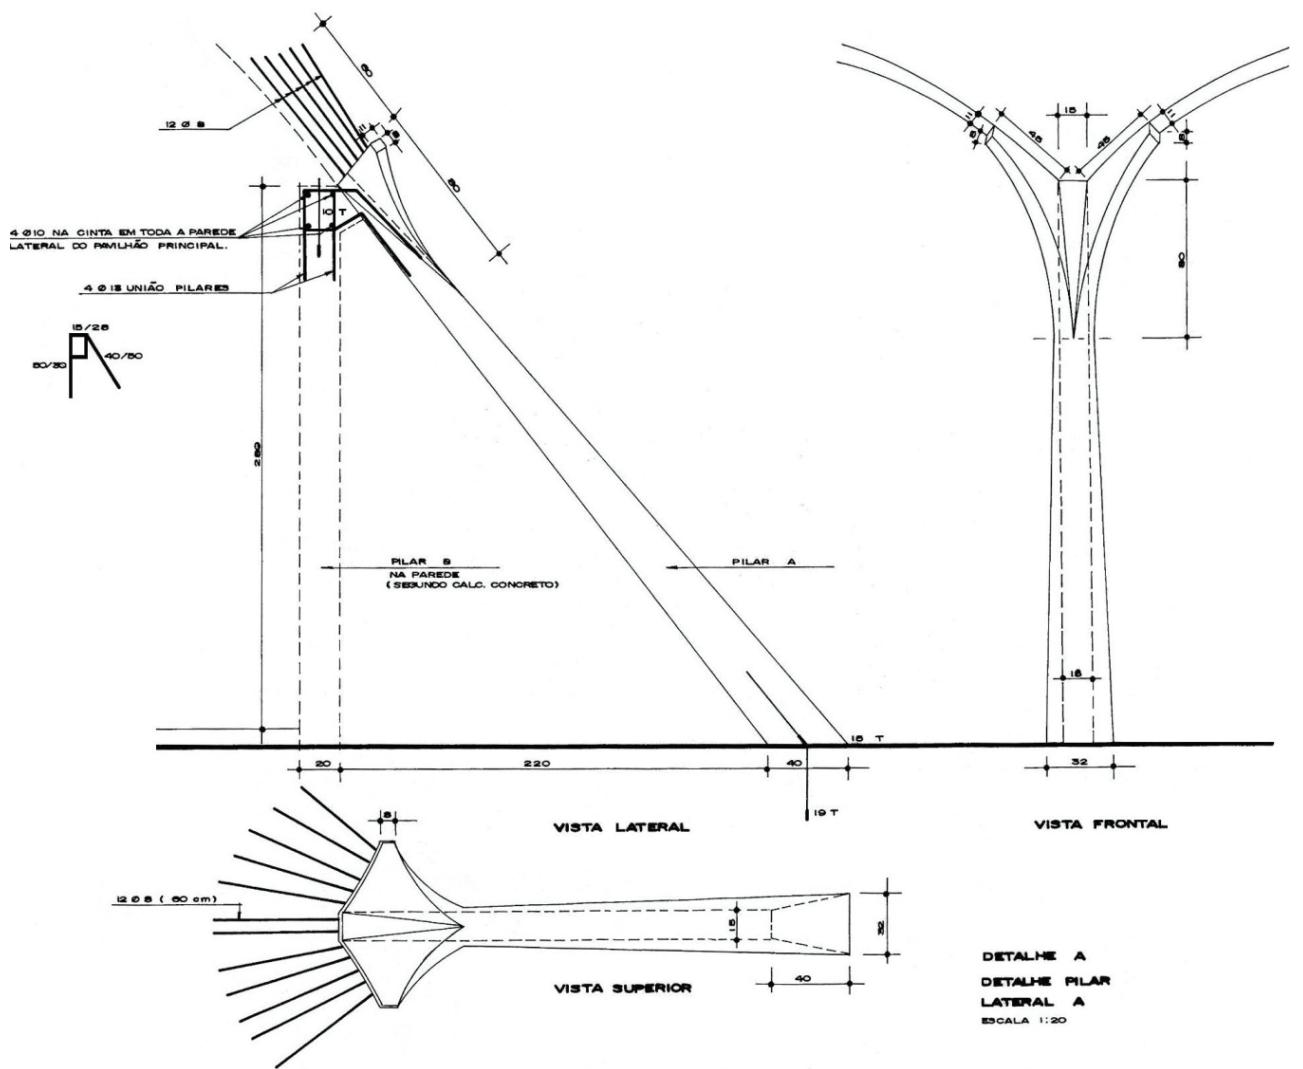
Detalhe do pilar inclinado. (*-5).
